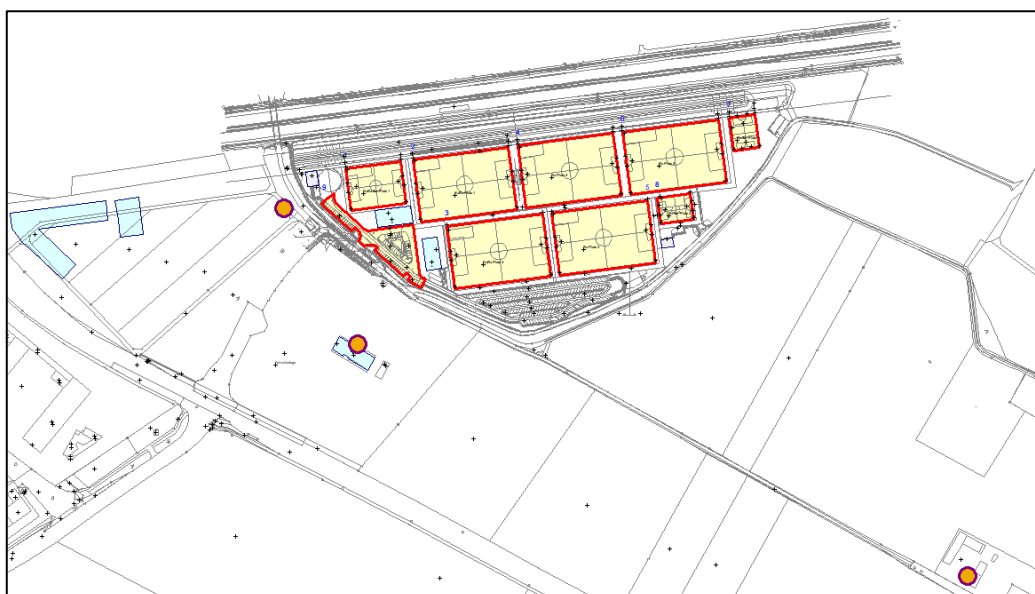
Lage Immissionsorte außerhalb des Bebauungsplans
